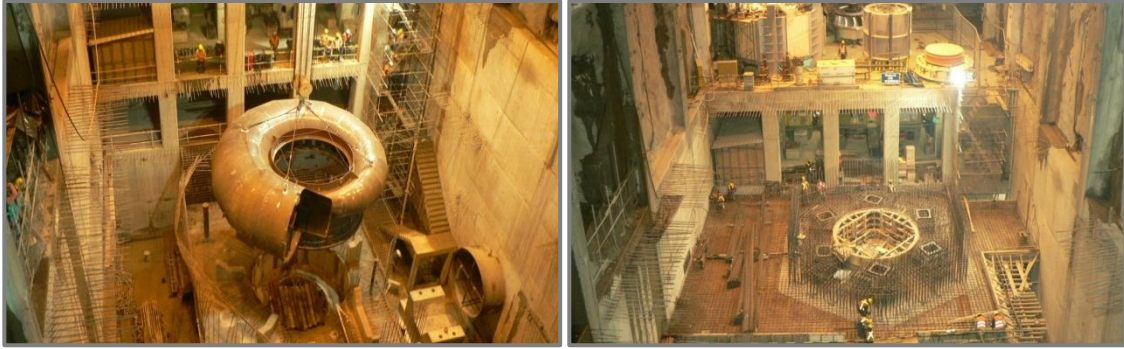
a) Puente grúa instalado en casa de máquinas, b) Excavación y hormigonado del área de los difusores (Fuente: Caminosca, 2011)
